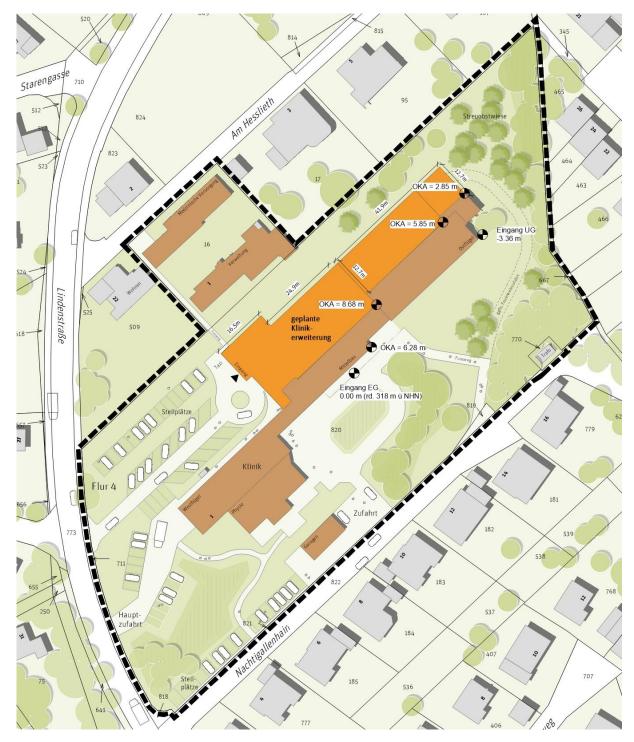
Bebauungskonzept Umbau und bauliche Erweiterung, Stand April 2023
